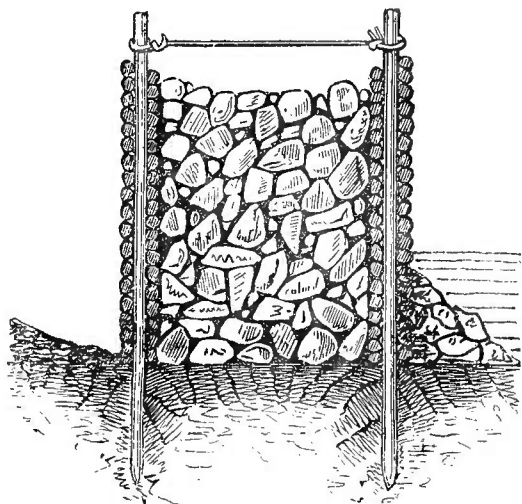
Protection de rives (bois et pierres) encaissées).
